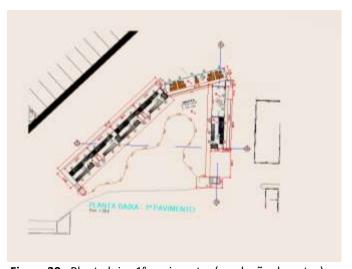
Planta lojas 1° pavimento. (produção do autor)
